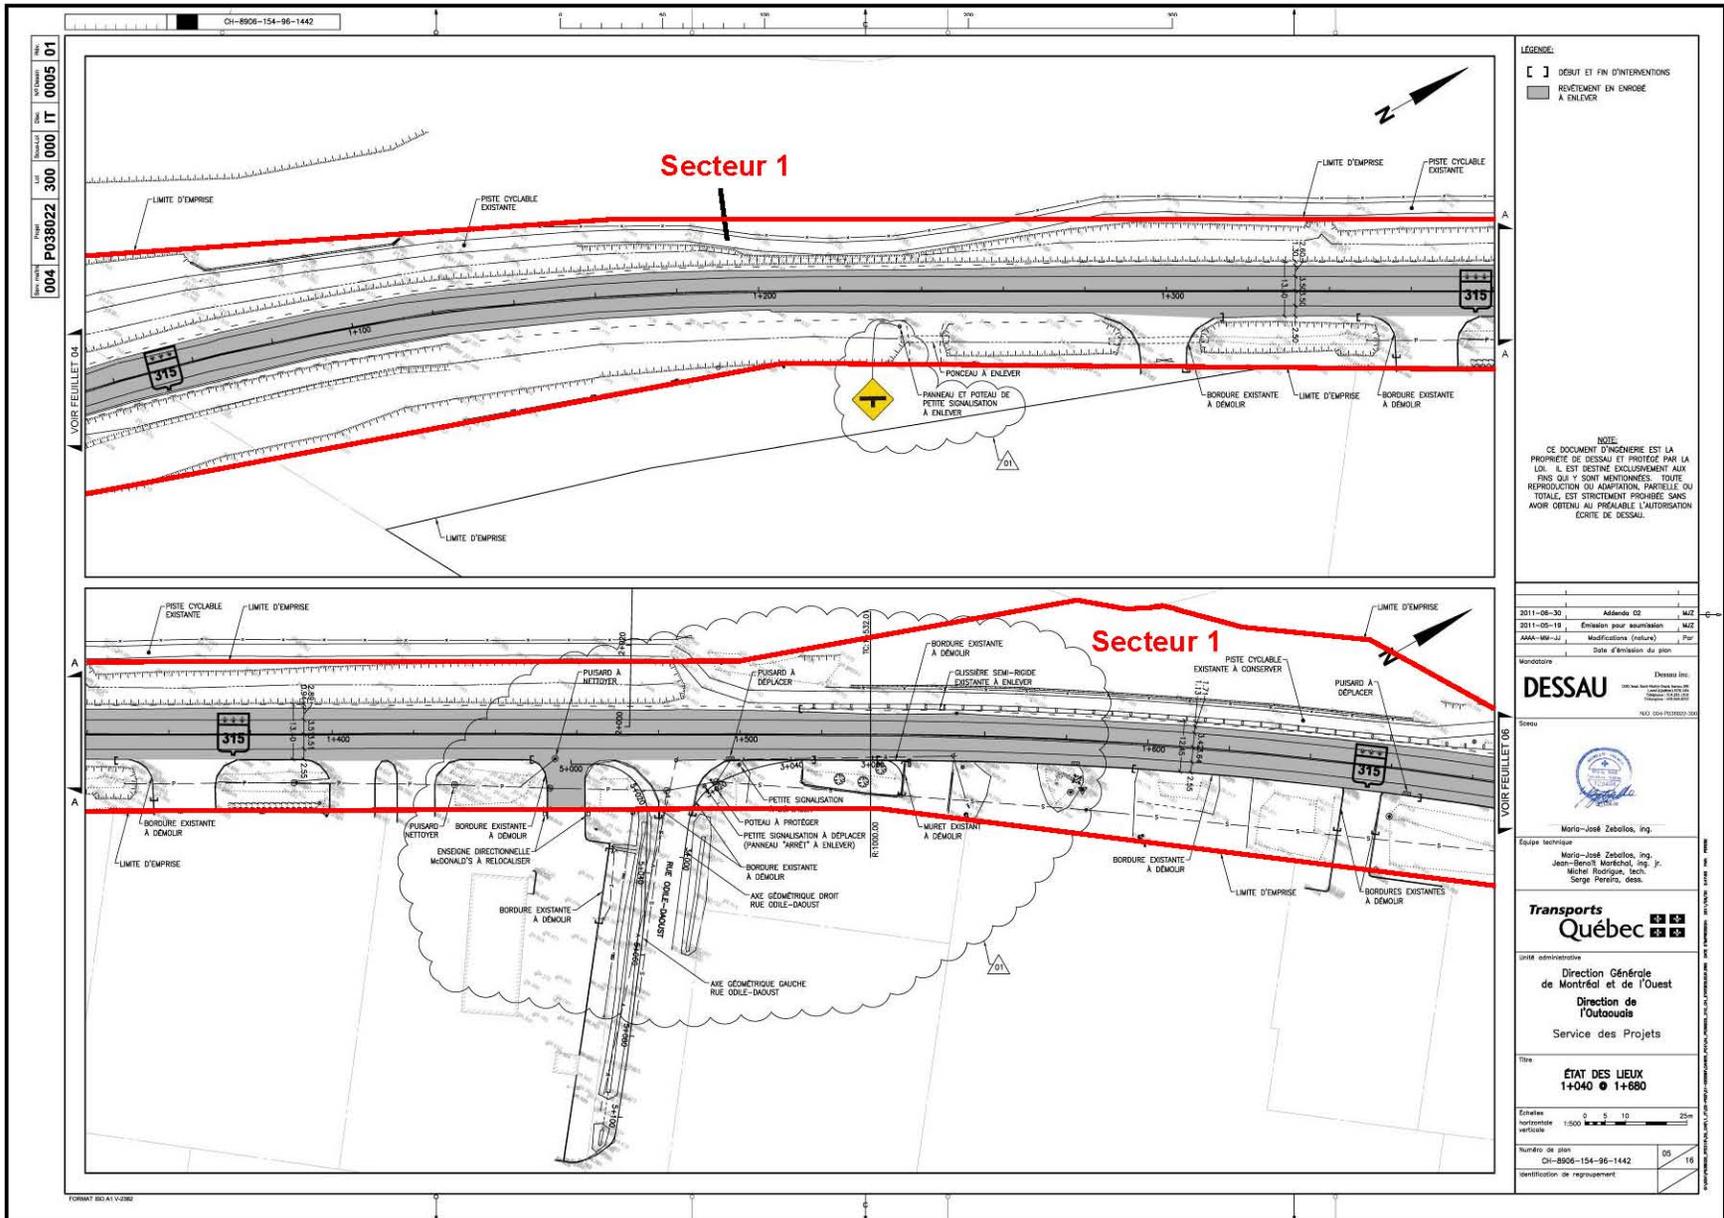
Localisation du secteur inventorié 1, projet n° 154-96-1442 (source : Ministère des Transports, plan d'ensemble [extrait], Plan d'ensemble – Travaux projetés, plan CH 8906-154-96-1442 (4/16), 30 juin 2011)
